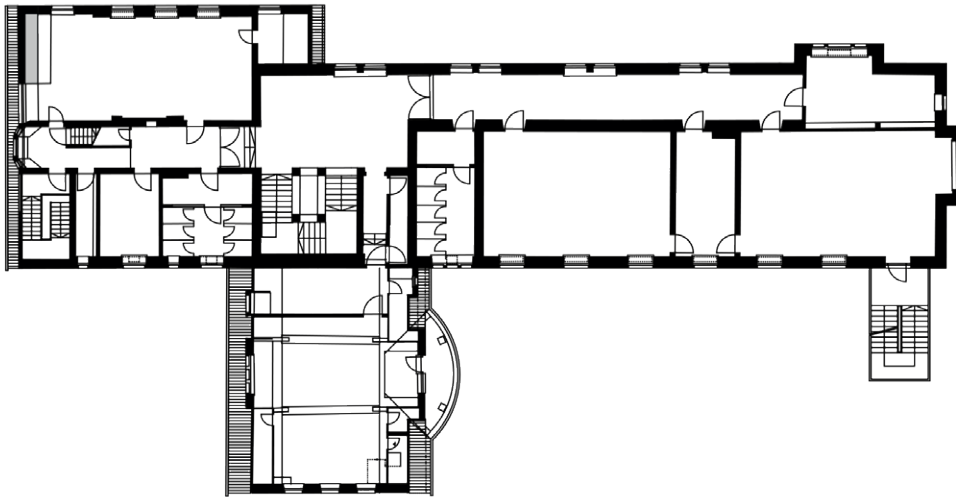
Grundriss 2. OG, M 1:400
